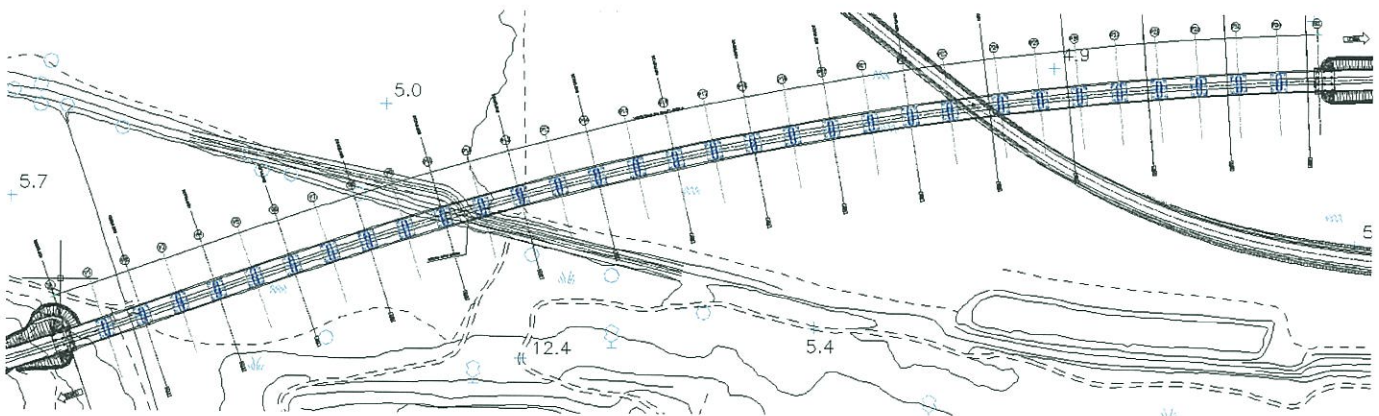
Viadotto Palude Capo d'Acqua: stralcio planimetrico
